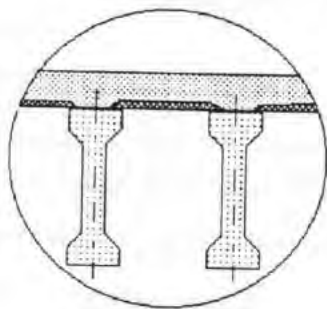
Coupe schématique d'un tablier à poutres précontraintes par pré-tension.
